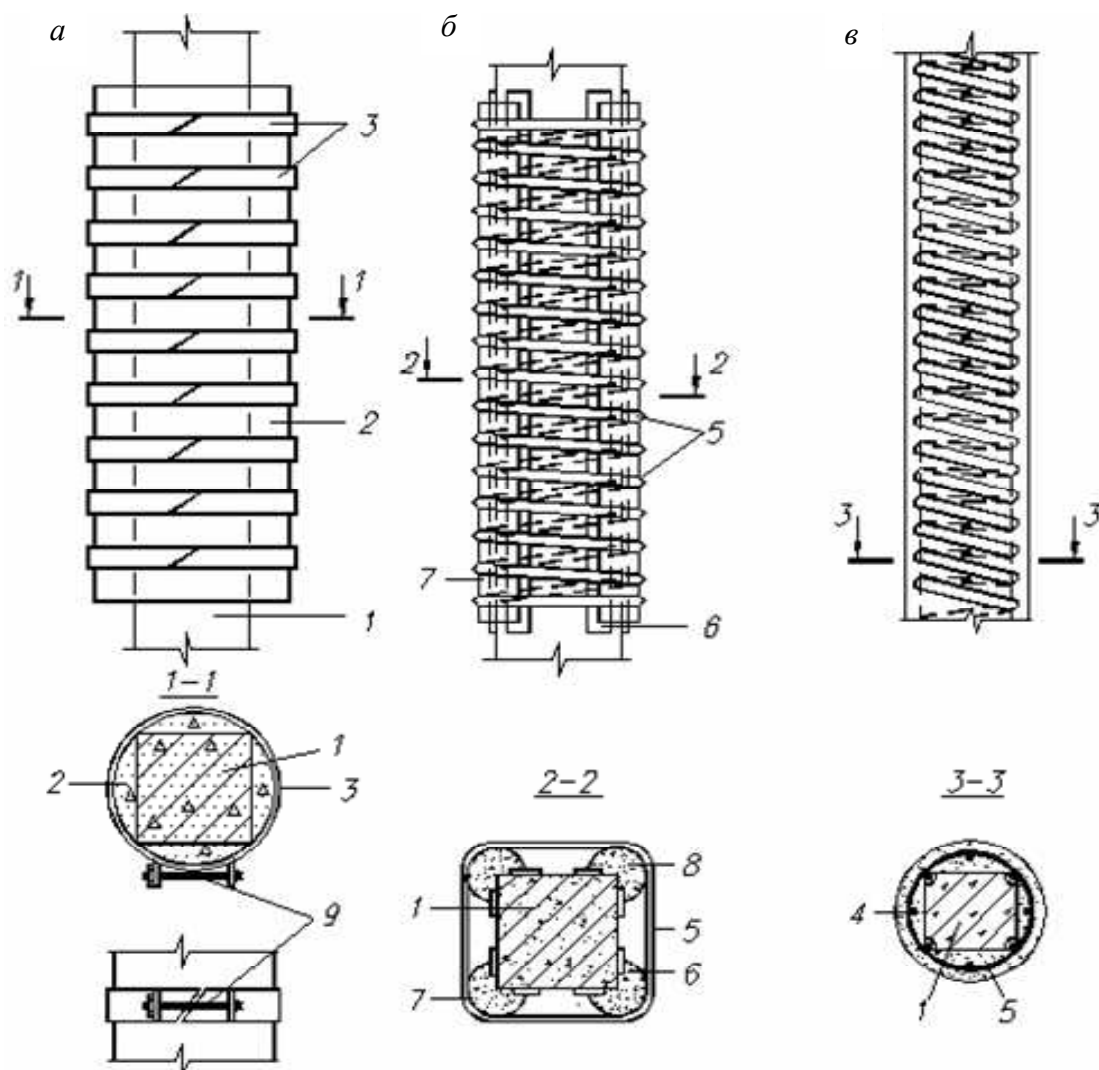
Усиление сжатых элементов установкой косвенной арматуры:
